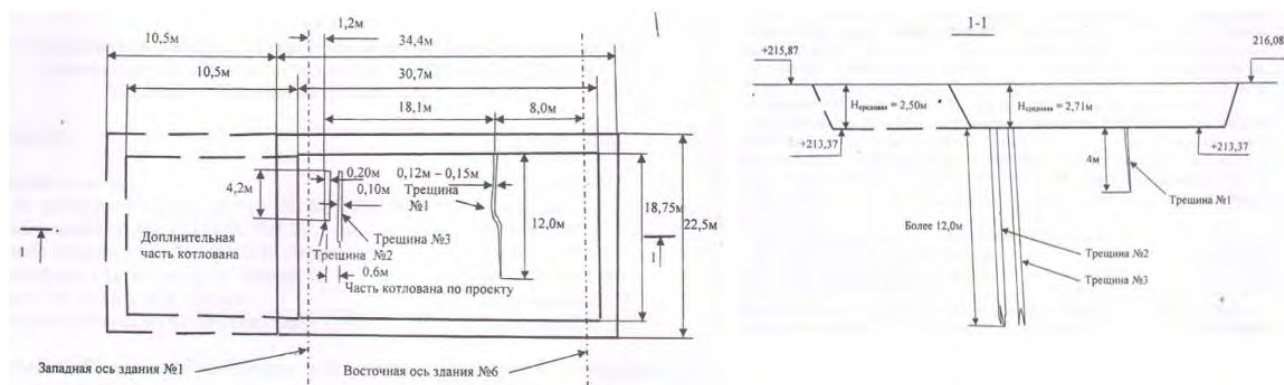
Схема котлована под здание водоотливного комплекса шахты им. Ленина с указанием обнаруженных трещин на дне котлована
